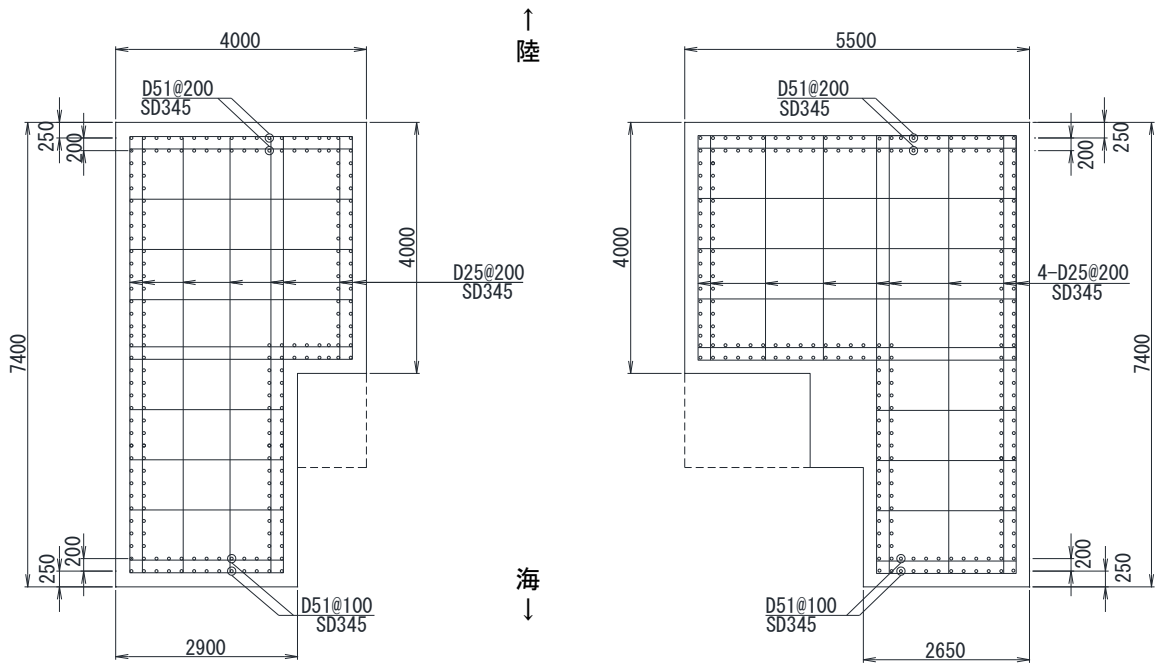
漂流物対策工戸当り (RC支柱) の概略配筋図 (A-A断面)
